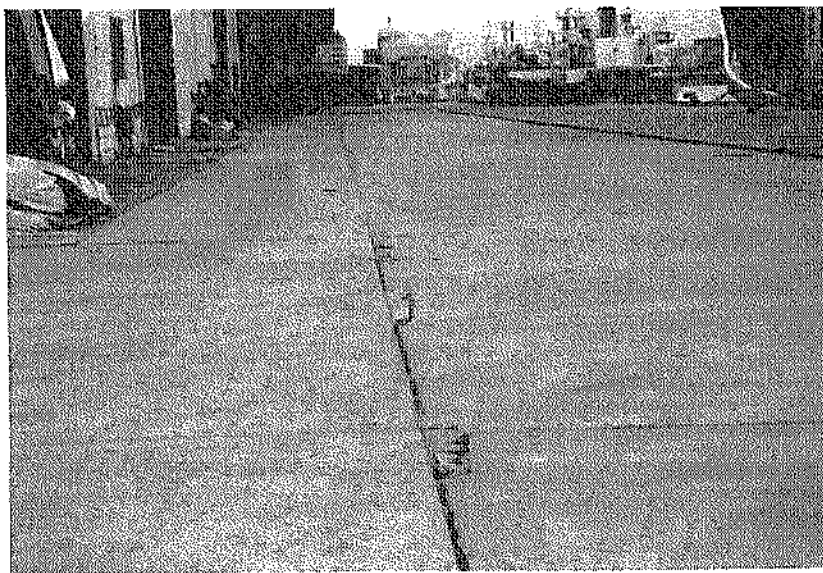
中央埠頭地区、③第5バース(-7.5m)
